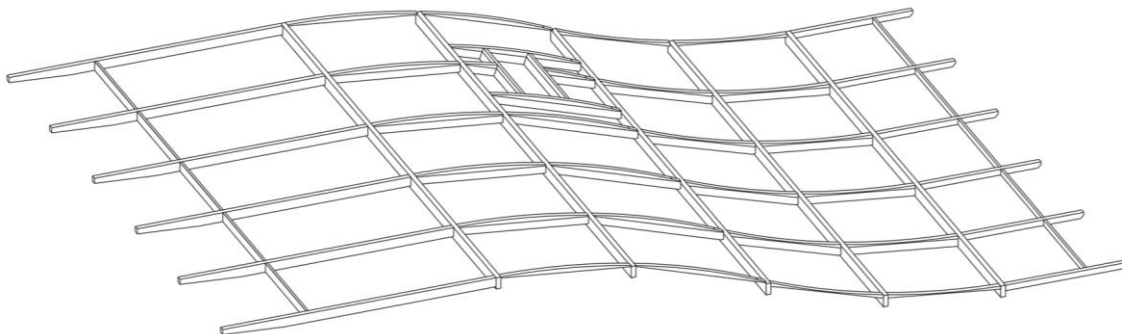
Charpente, poutres – document de fabrication des Charpentiers du Haut Beaujolais
